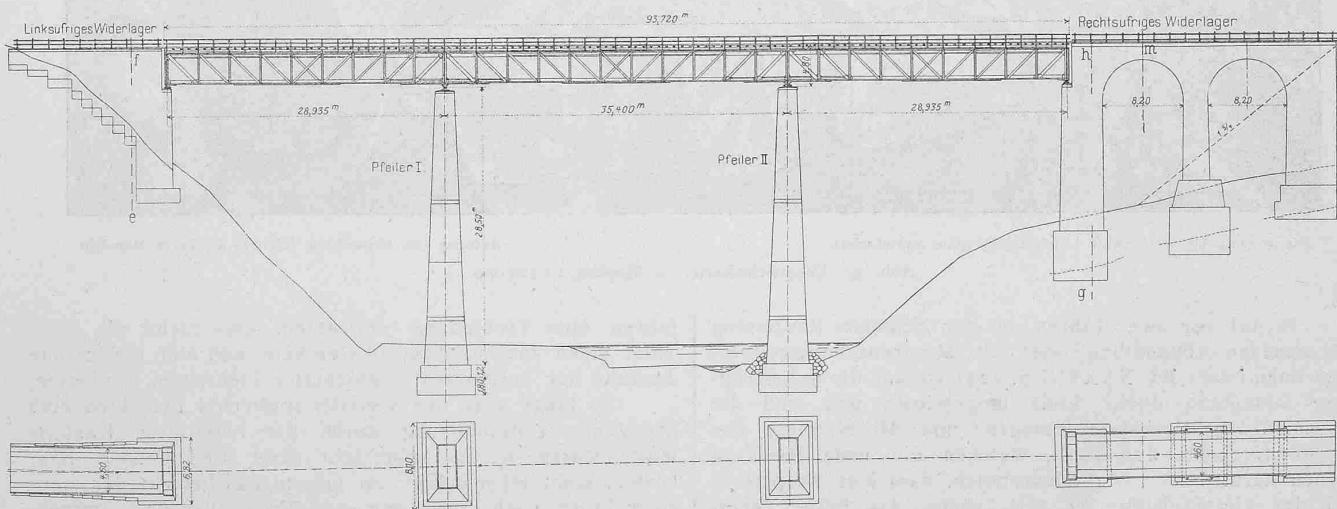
Brücke über den Bunschenbach. — Ansicht und Grundriss. — Masstab 1:700.
